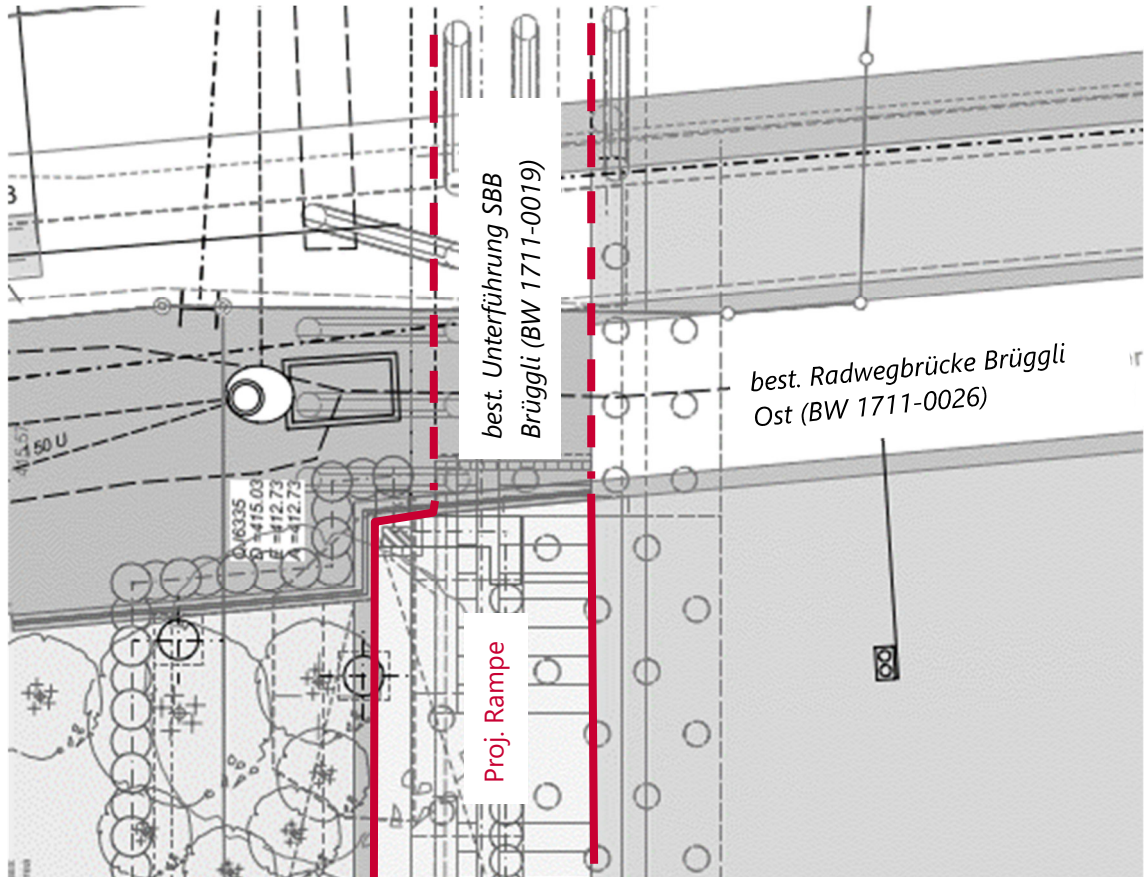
projektierte Zugang gemäss genehmigtem Auflageprojekt
